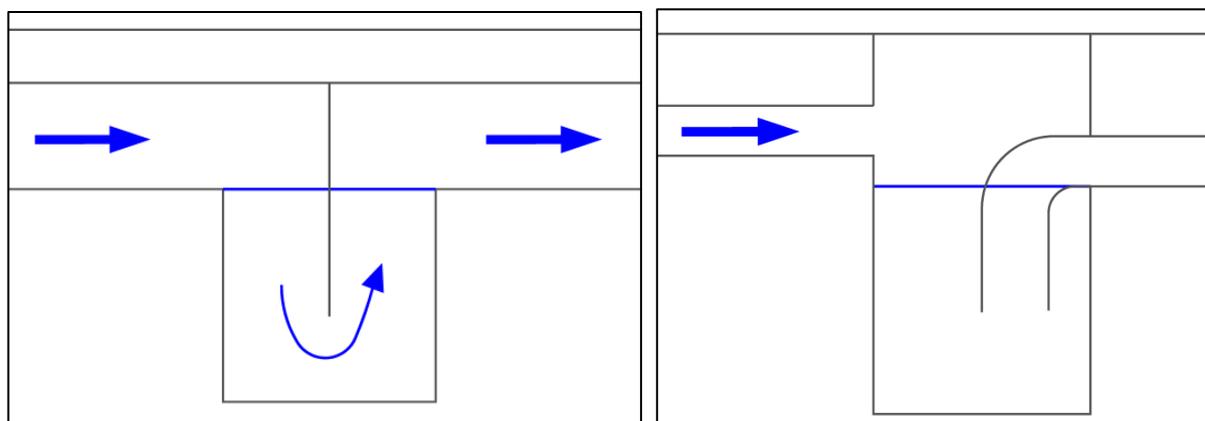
Schémas de principe de 2 exemples de zones de décantation (cloison siphonoïde et coude PVC)
